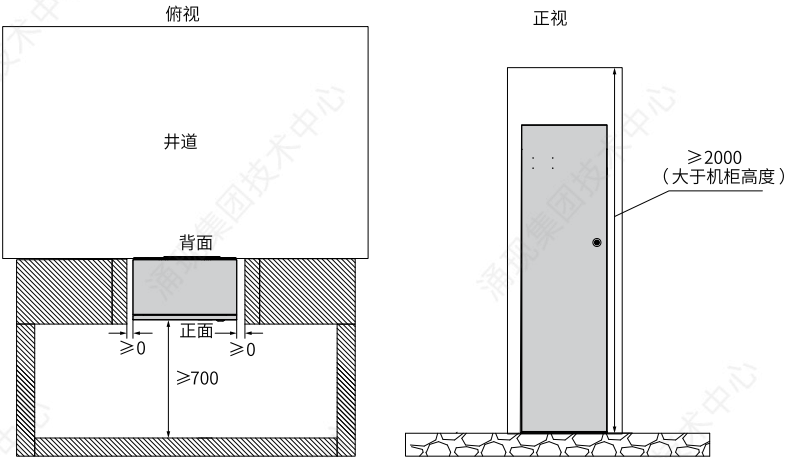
无机房控制柜安装空间要求示意图（单位：mm）
